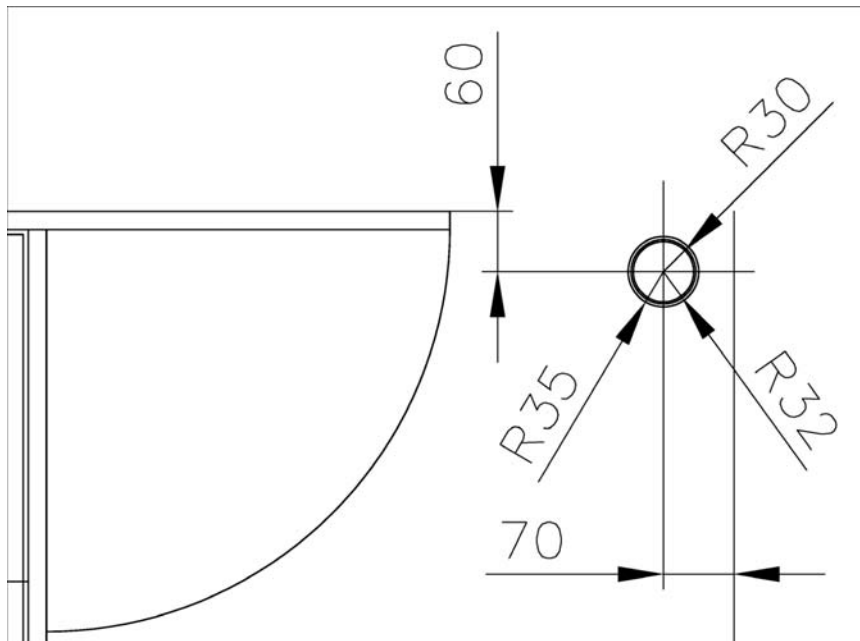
Размеры боковой опоры и расположение ее на чертеже
